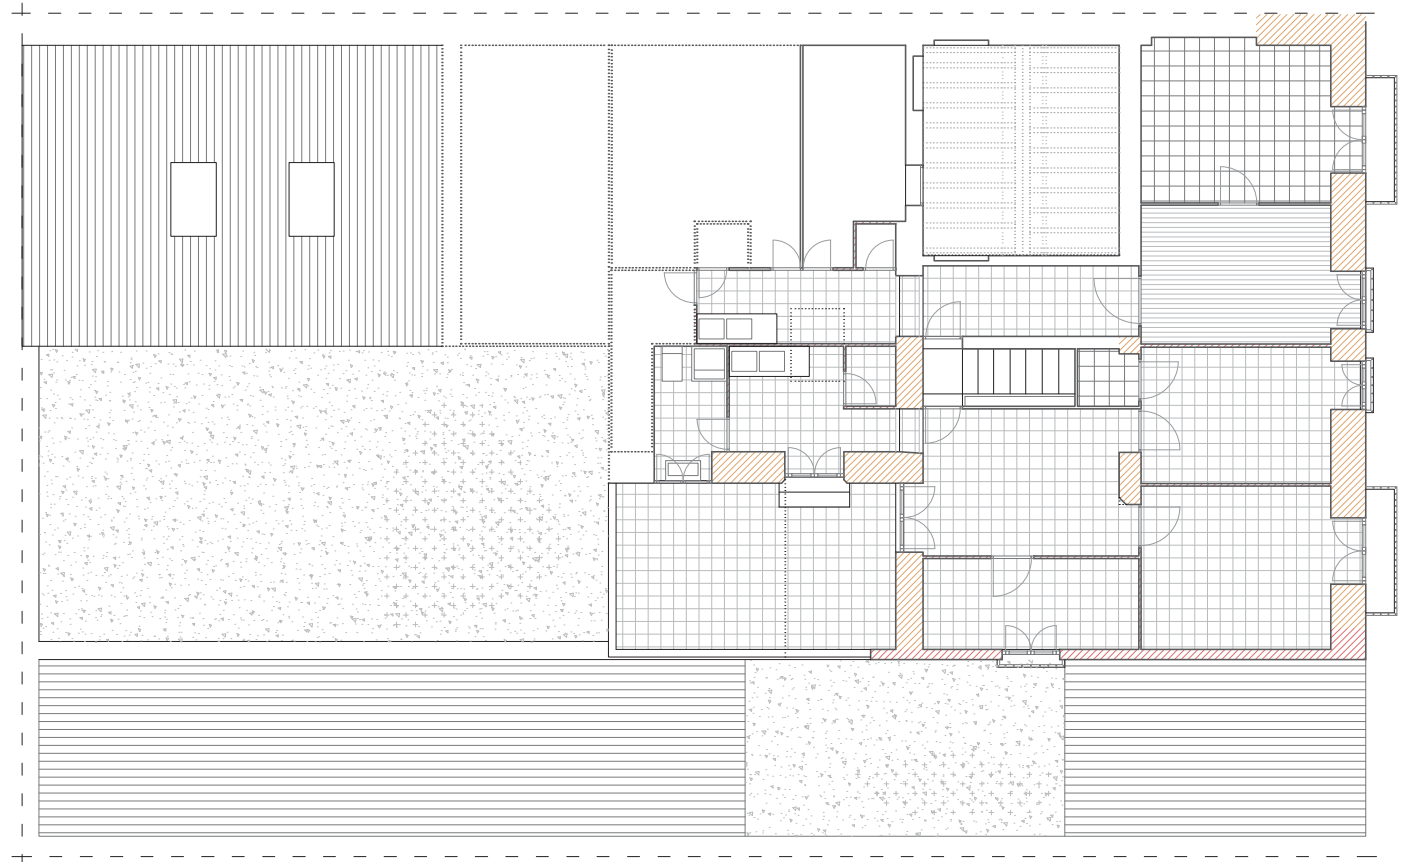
Planta segunda (Fuente: elaboración propia)
